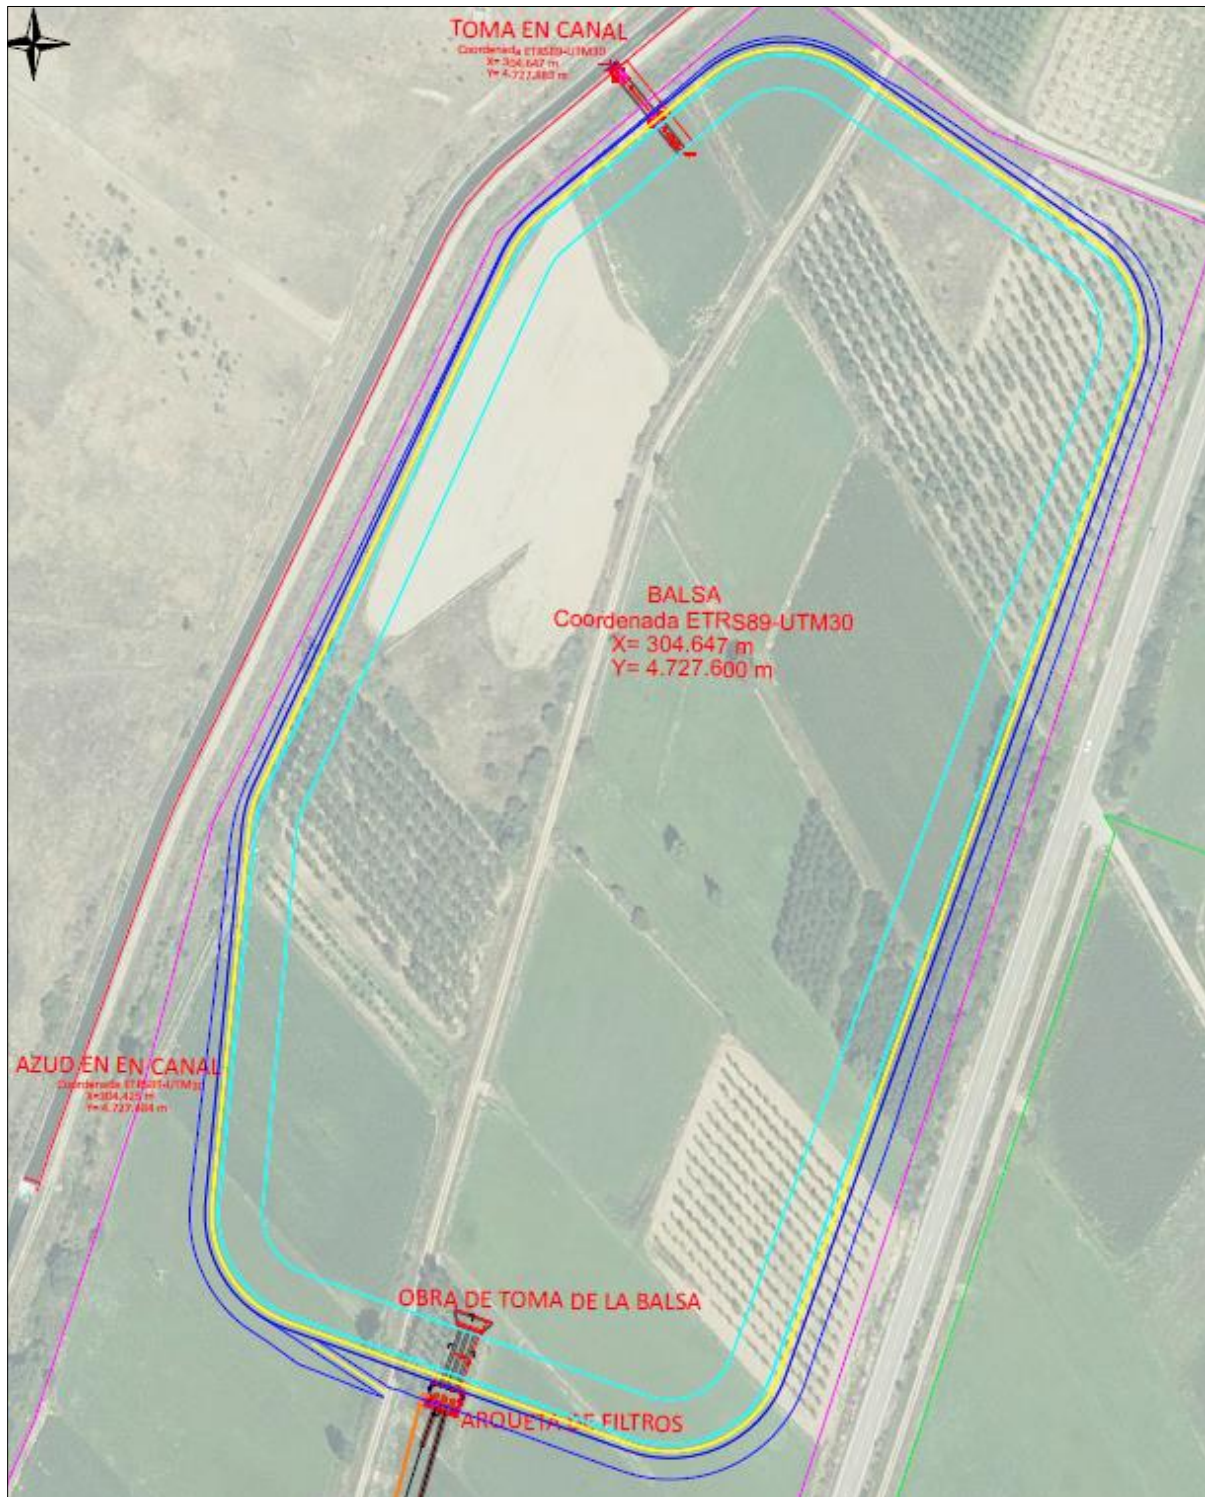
Vista en planta de la ocupación de la balsa de riego y su recinto.
